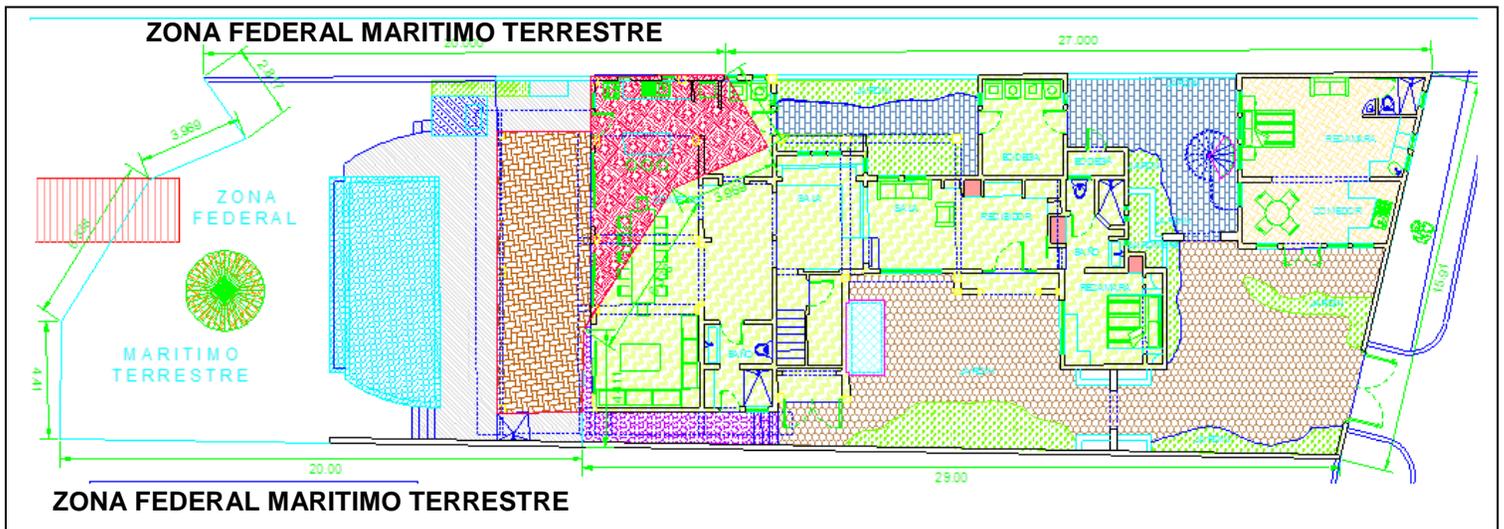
Plano de Obras a Remodelar en la Planta Baja del Lote 12
